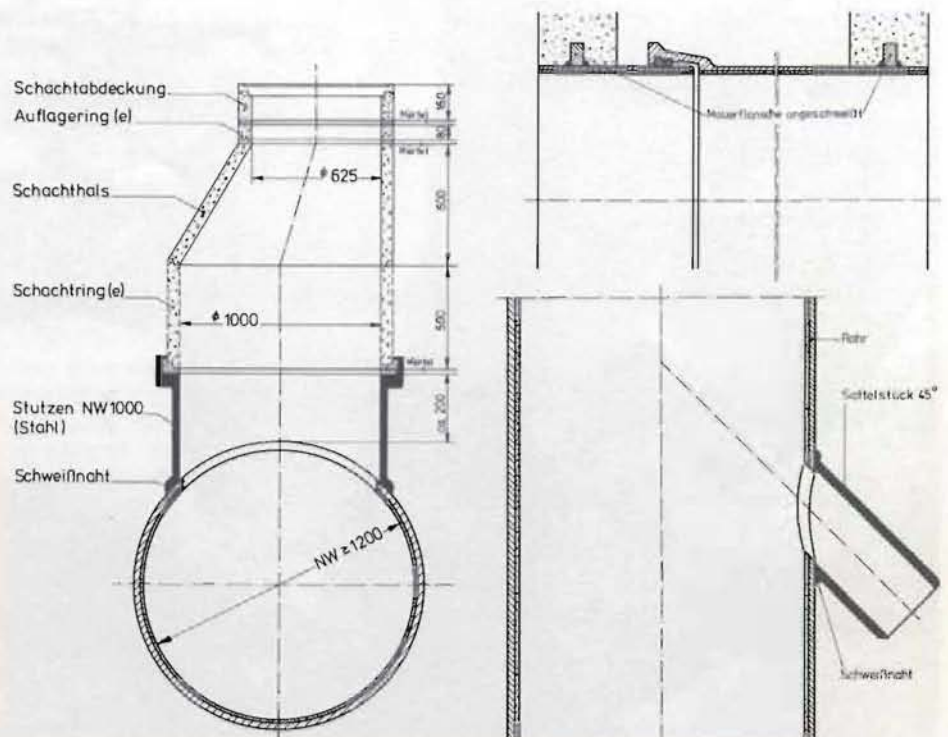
Schweißkonstruktionen für Einstiegschächte, Schachteinbindungen und Anschlußstücke
